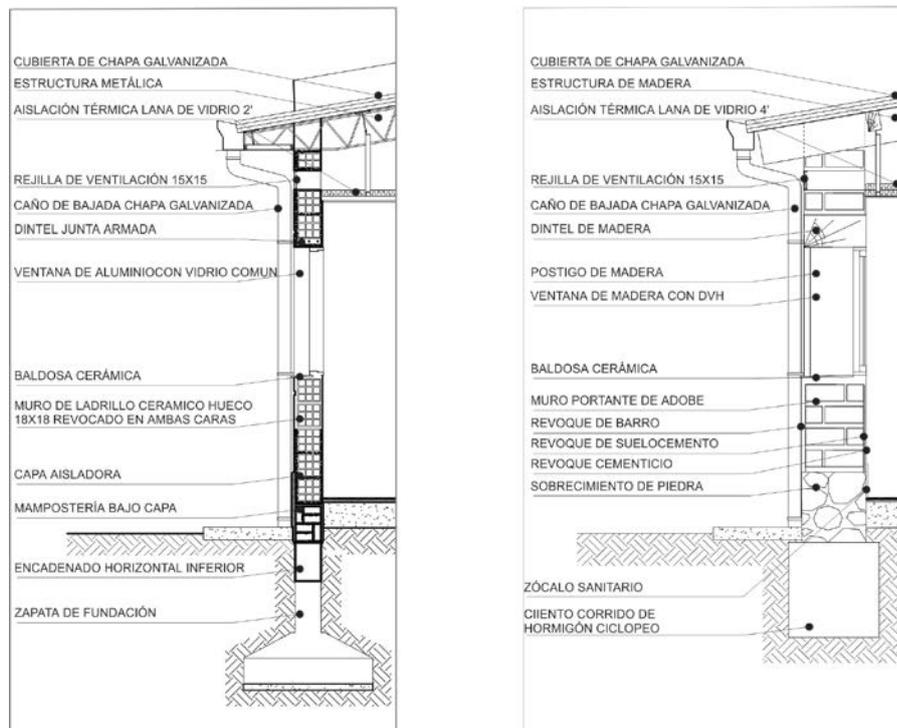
Detalle constructivo envolvente existente y propuesta de re- diseño.
